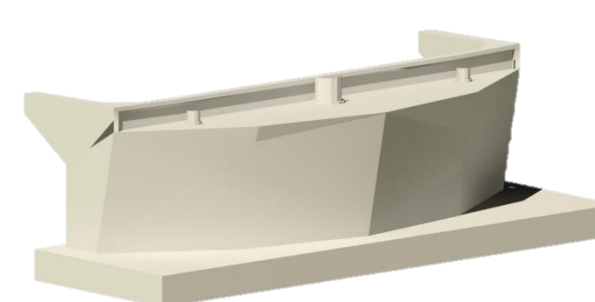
ESTRIBO LADO OBERLANDSTRASSE
